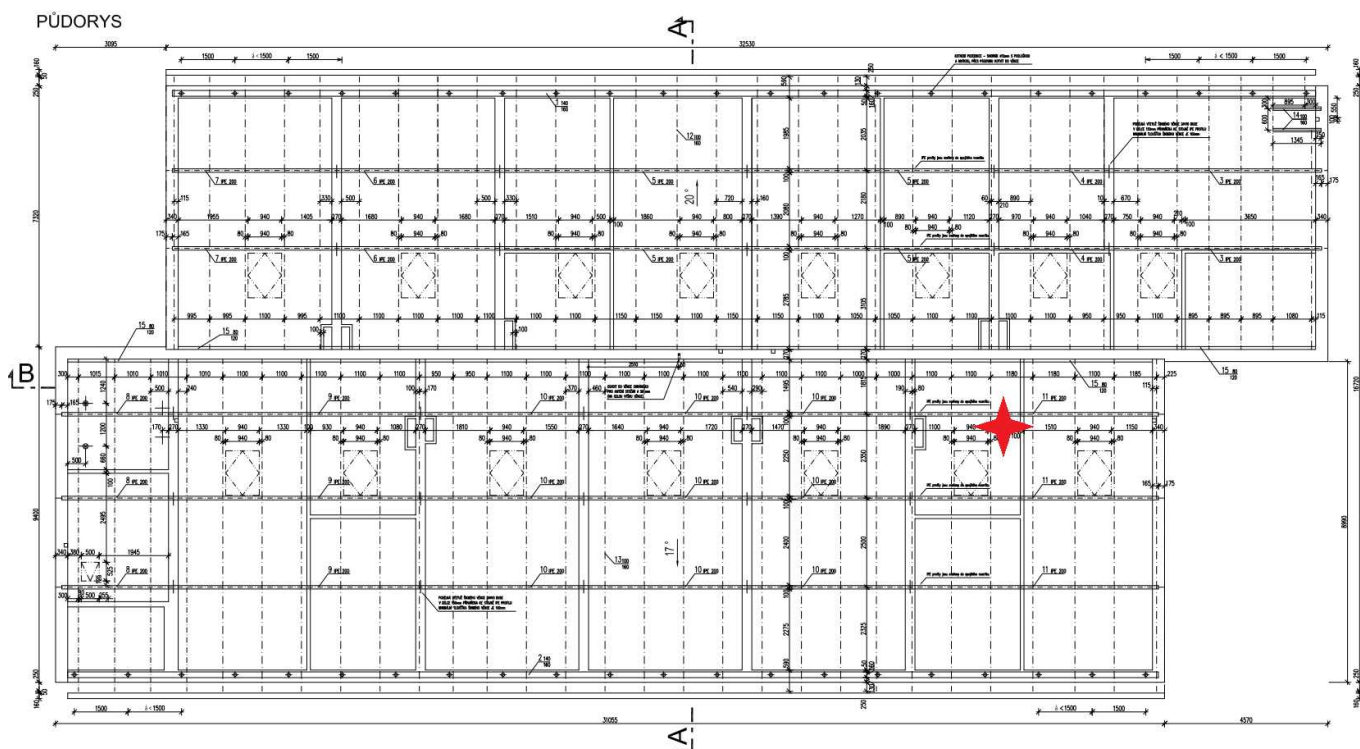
/ Poloha provedené sondy v půdorysu krovu střechy dle [9] (červeně, severní strana je napravo)
